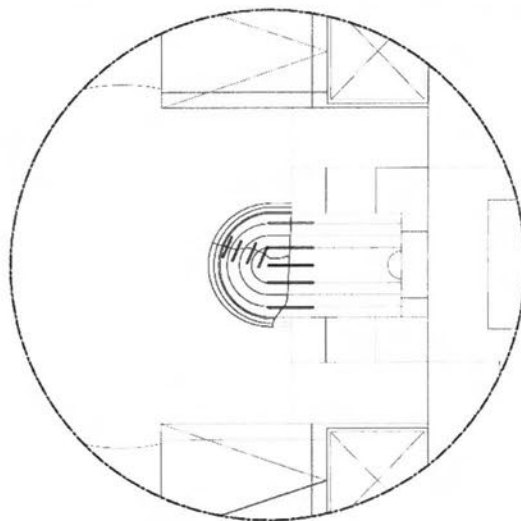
Plano de detalle reintegración fuente fachada oriente. Fuente: Municipalidad de Providencia
